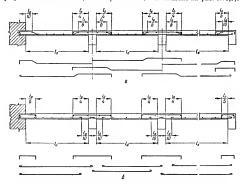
78. Армирование многопролетных балочных плит вязаной арматурой: а – при наличии отгибов; б – при отсутствии отгибов (раздельное армирование).
